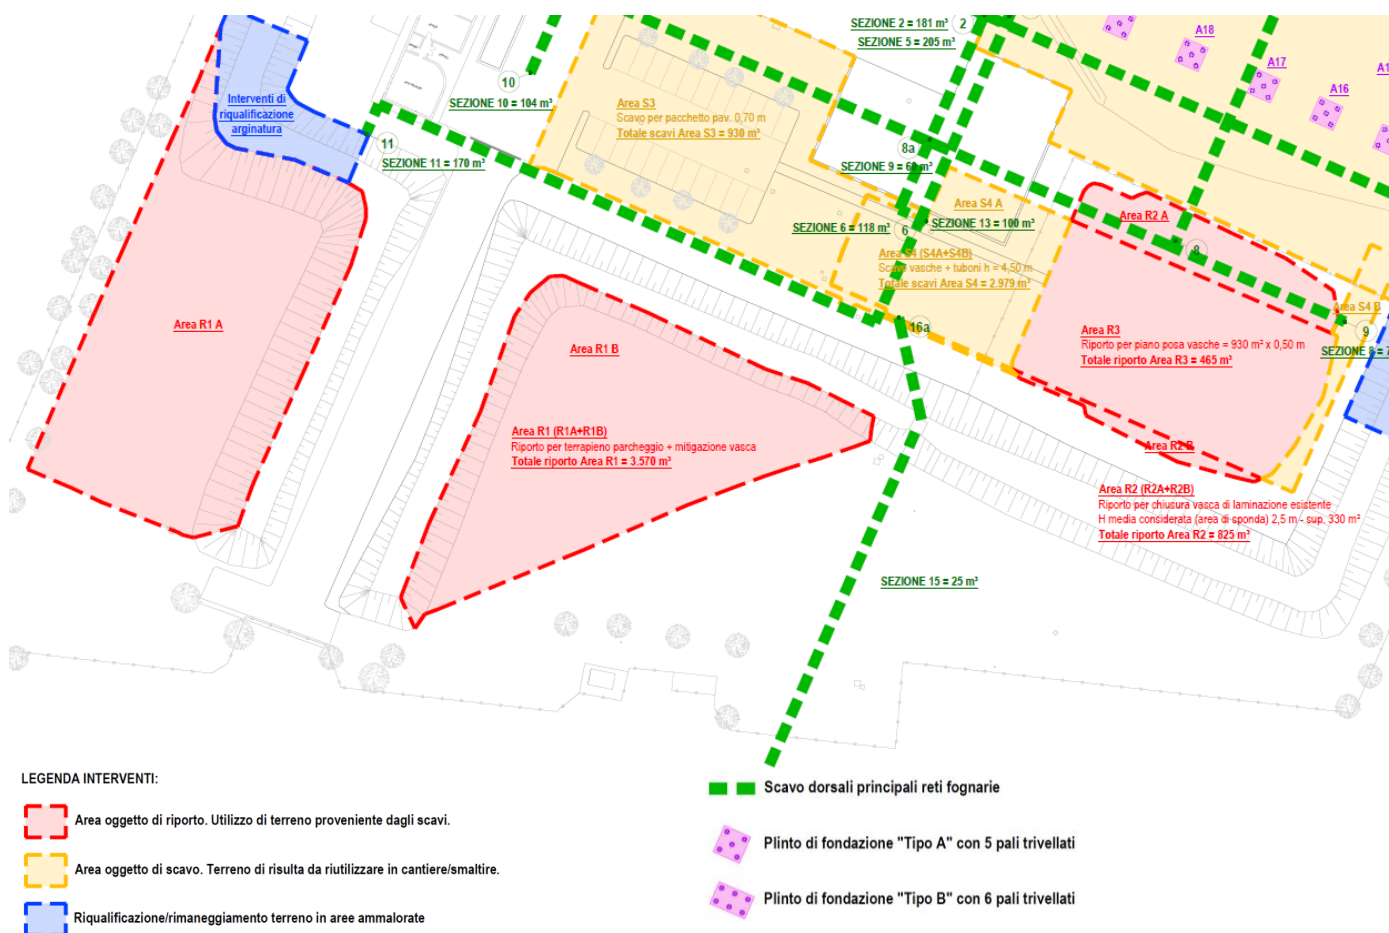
Ubicazione di utilizzo delle Terre e Rocce da scavo all'interno del cantiere
